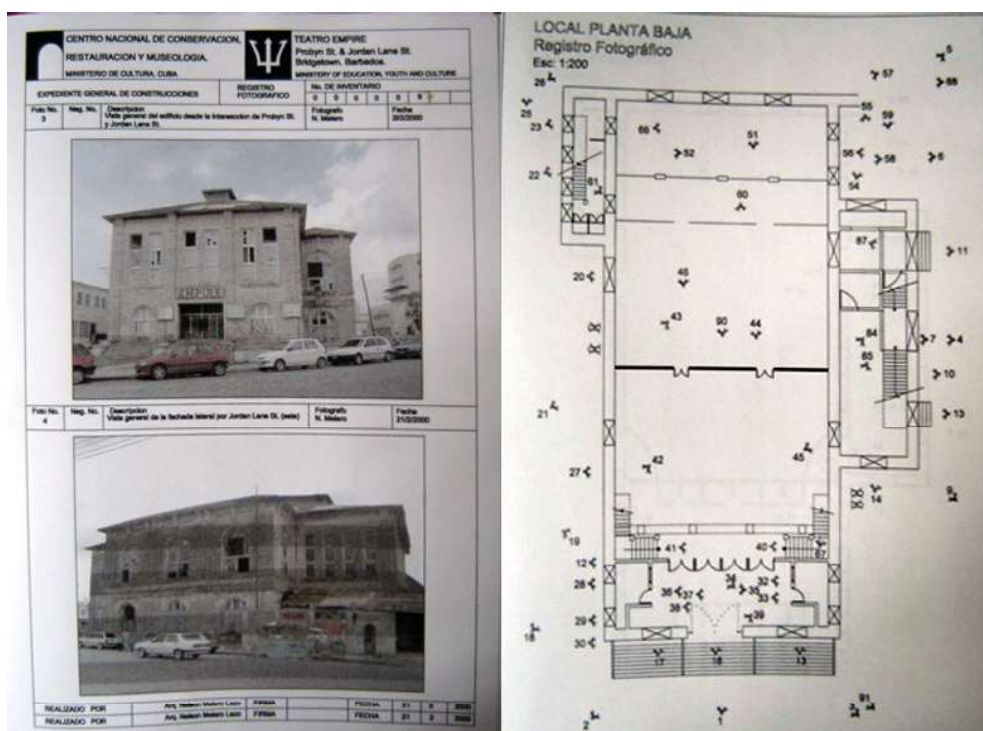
Por la izquierda la Planilla del Registro fotográfico para el levantamiento. Teatro Empire. Bridgetown. Barbados. Fuente (Melero, 2002). Por la derecha el plano de planta con la ubicación del registro fotográfico. Teatro Empire. Bridgetown. Barbados. Fuente: Melero, 2002.
